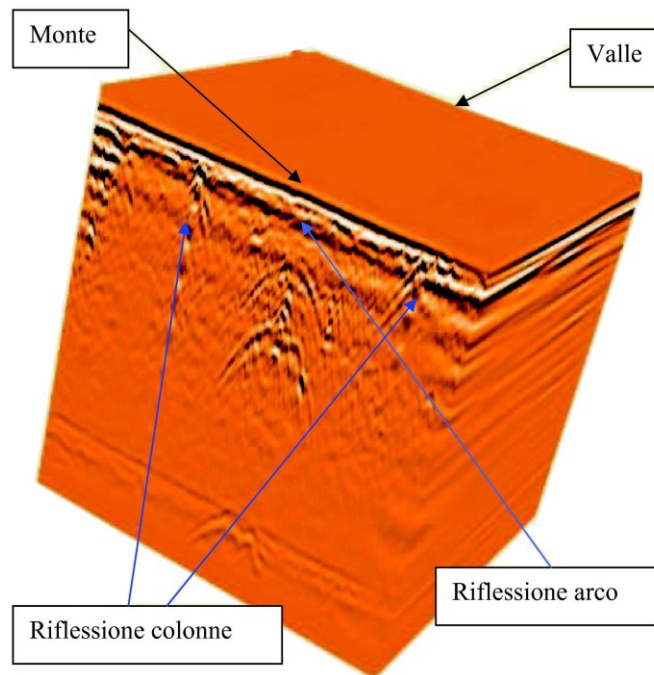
d. Vista 3D profilo 5 sopra il ponte
